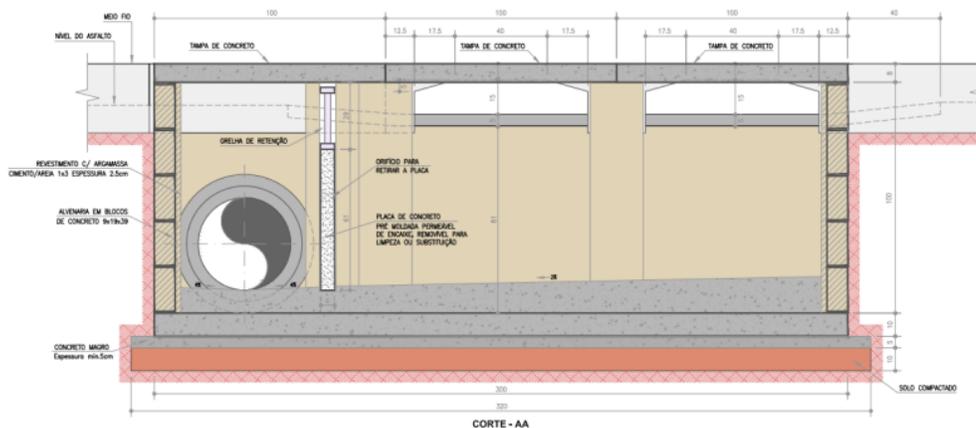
Corte esquemático da boca de lobo dupla de retenção
